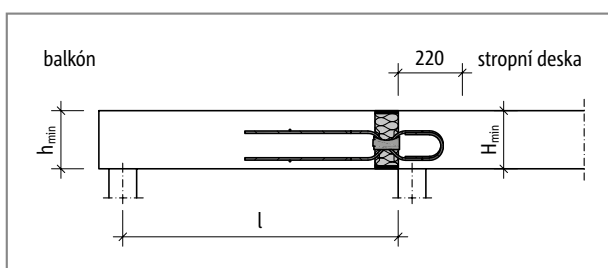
Schöck Isokorb® T typ QL-V4 až QL-V6: Statický systém
